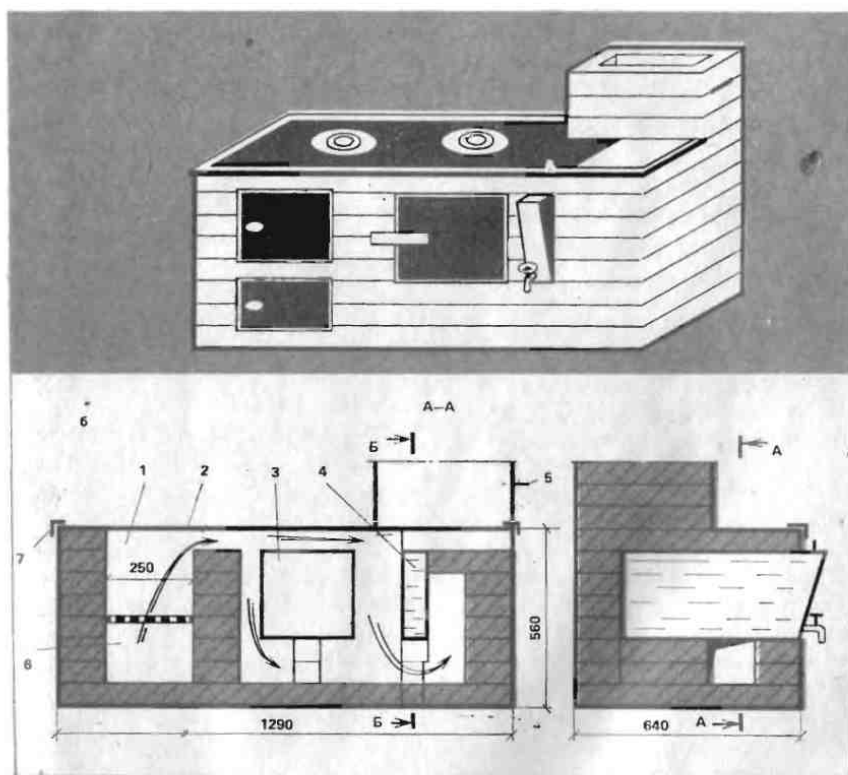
Кухонная плита с жарочным шкафом (духовкой) и водогрейной коробкой а — общий вид; б — разрезы; 1 — топливник; 2 — чугунная плита; 3 — духовка; 4 — водогрейная коробка; 5 — дымовая задвижка; 6 — зольниковая камера; 7 — обвязка из угловой стали
